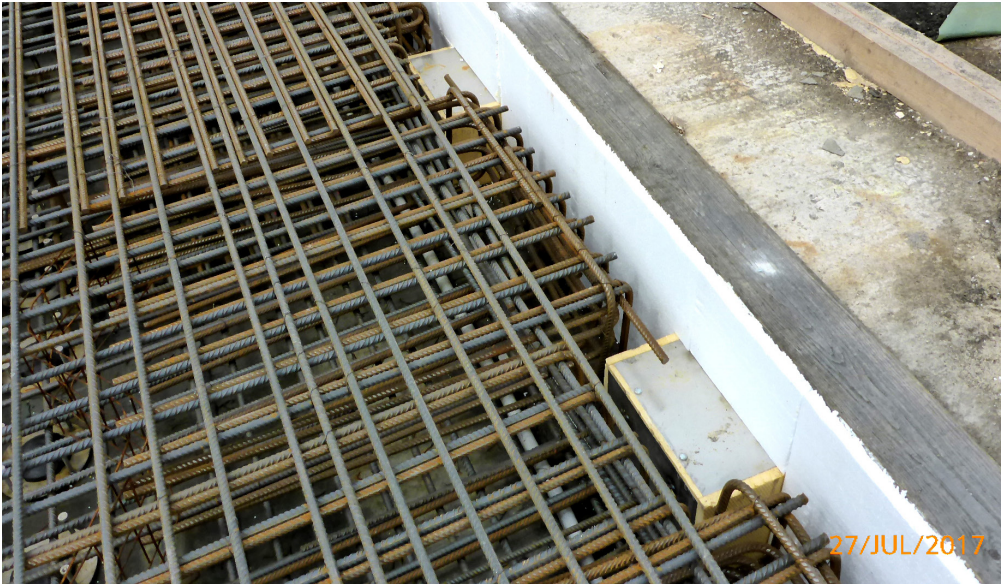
In die Bewehrung eingebundene Kraftsensoren vor dem Betonieren
